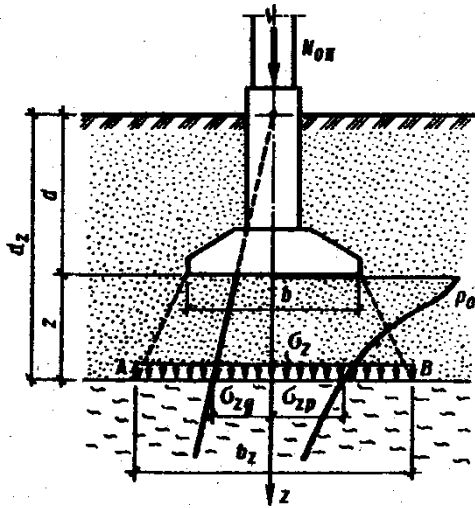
Расчётная схема к проверки давления на подстилающий слой слабого грунта
